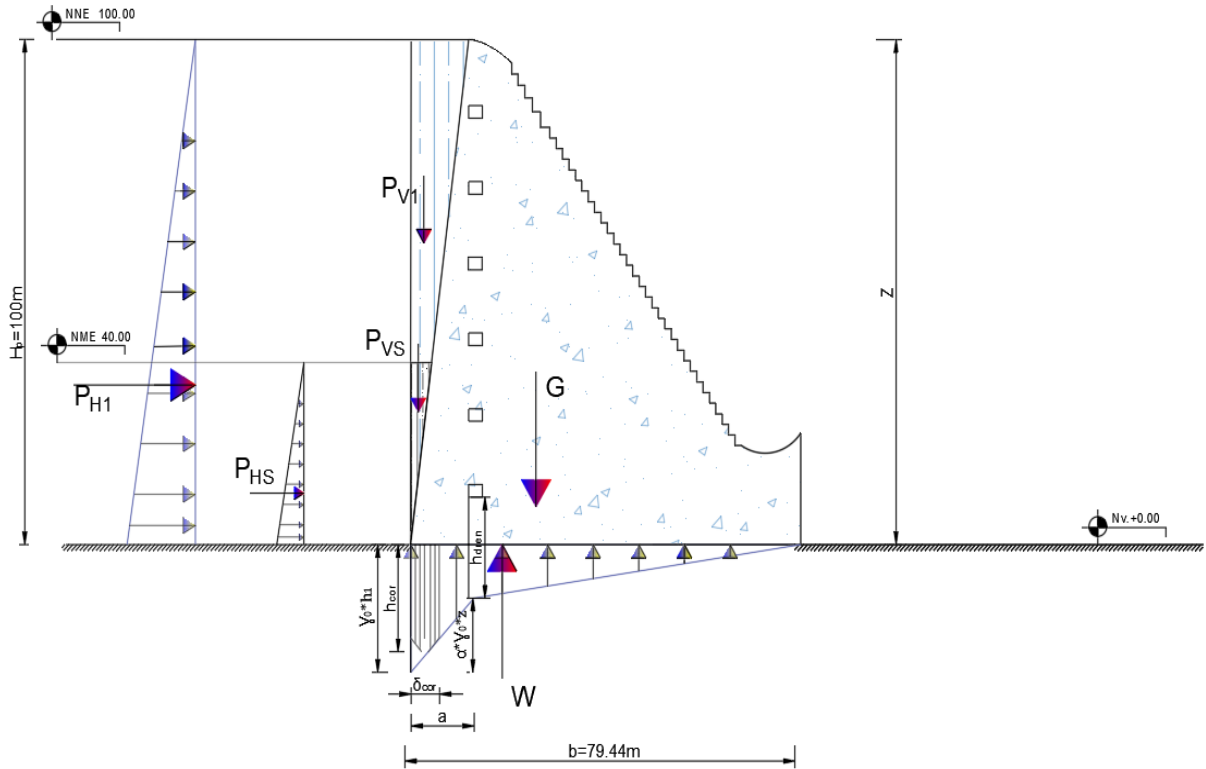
Fuerzas actuantes para el cálculo del perfil constructivo de la presa de HC para combinación B1
